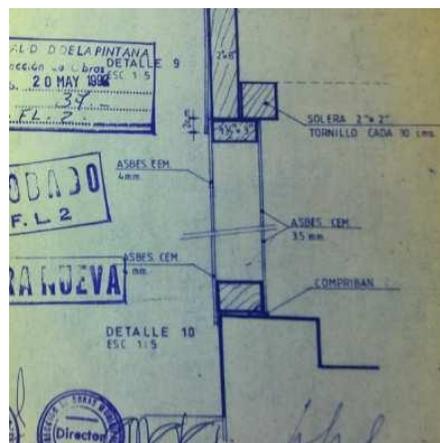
detalle tipo de tabique con revestimiento de asbesto.
